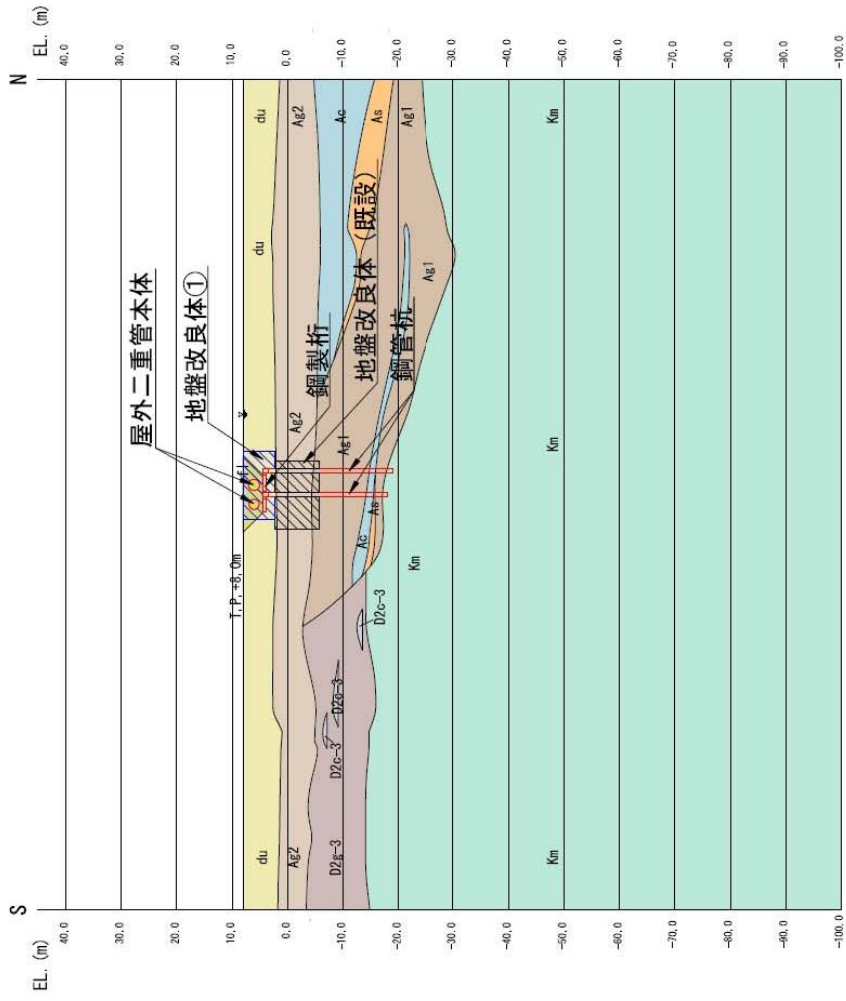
(3) 屋外二重管の評価対象断面図 (C-C 断面)
